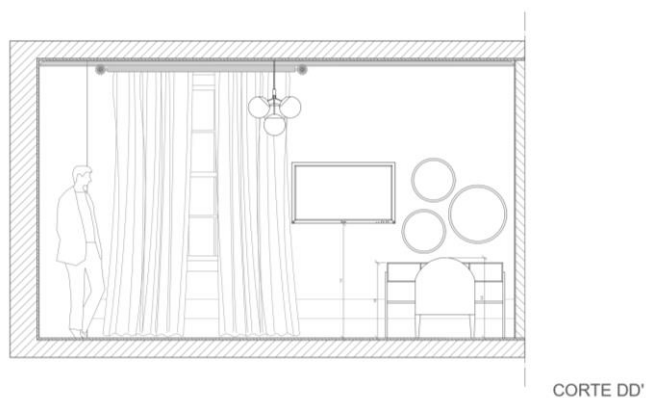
Pormenorização. Corte DD’. Fonte: Ana Ferreira
